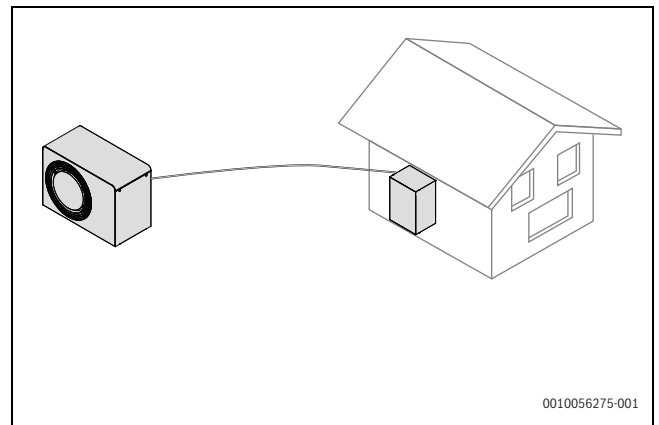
Collegamento CAN-BUS tra l'unità interna e l'unità esterna
